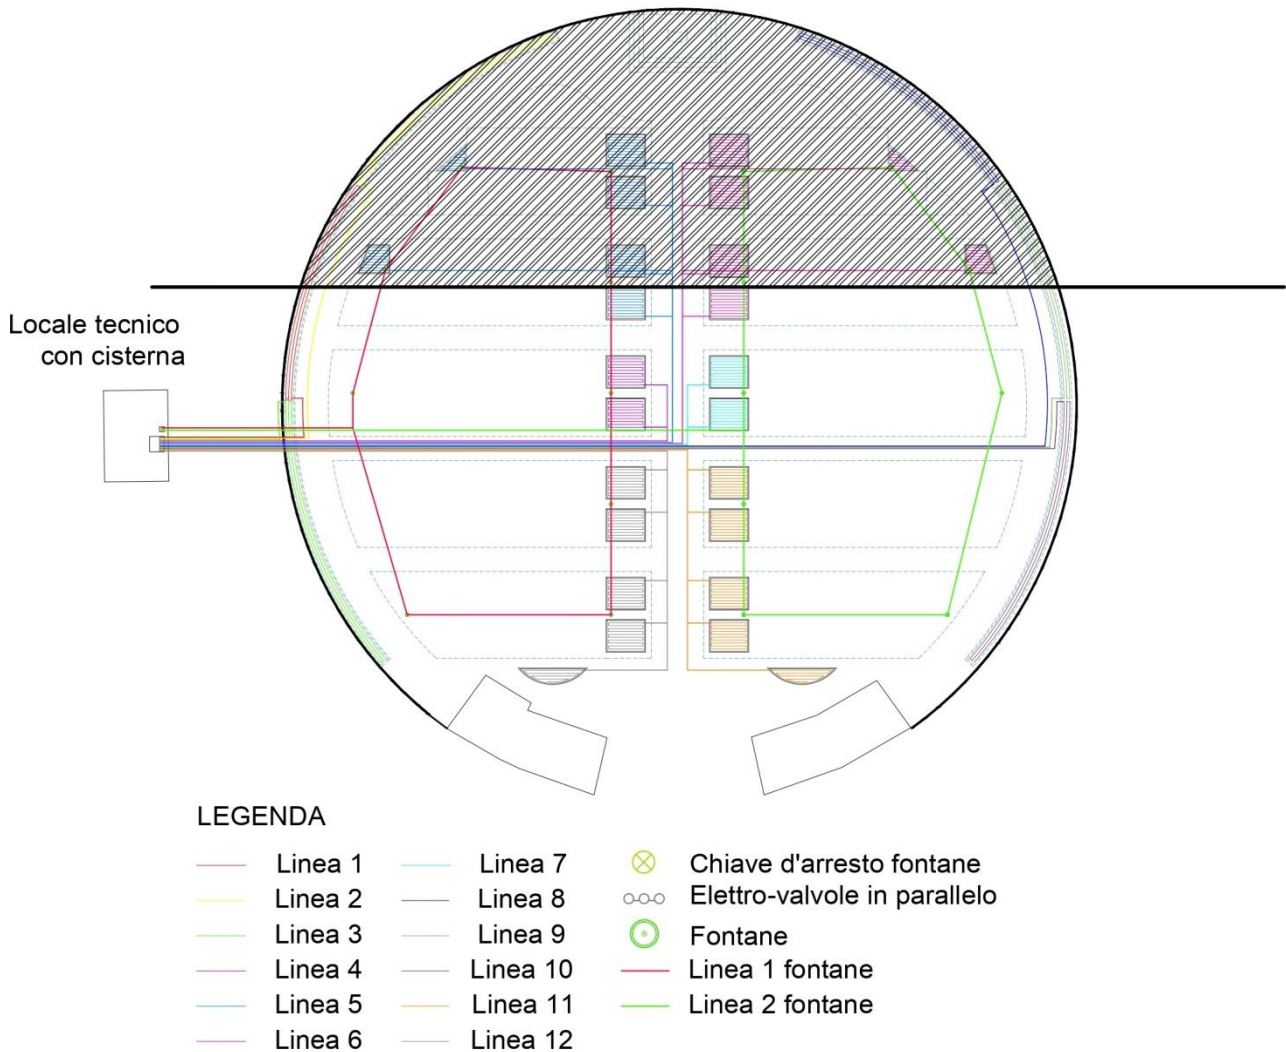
Schema impianto di irrigazione con divisione tra lotto 1 (in basso) e lotto 2 (in alto oscurato).
